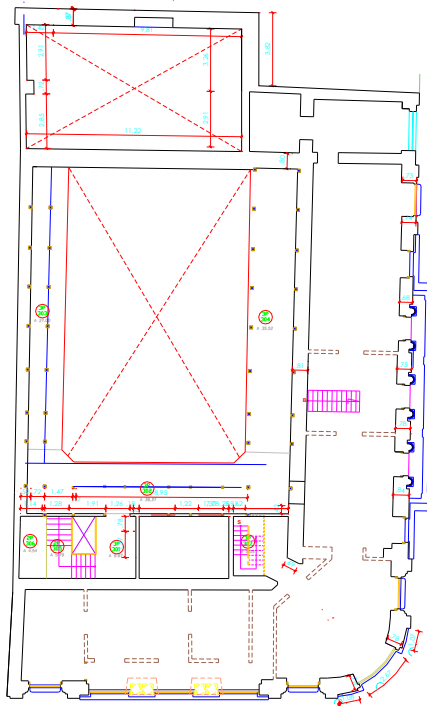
Levantamiento arquitectónico tercer palco – tercer piso alto
